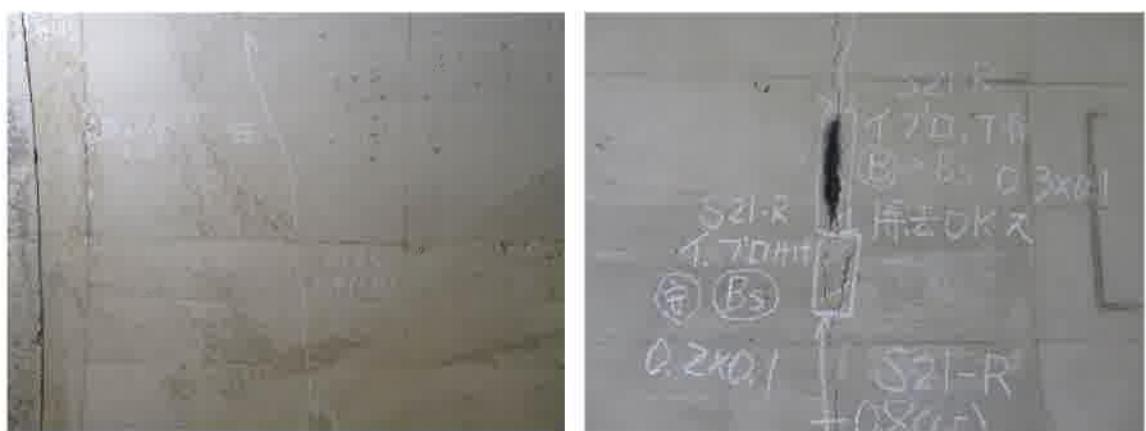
左：横断方向のひび割れ S010、右：ひび割れ沿いのうき S021（IIb 判定）
